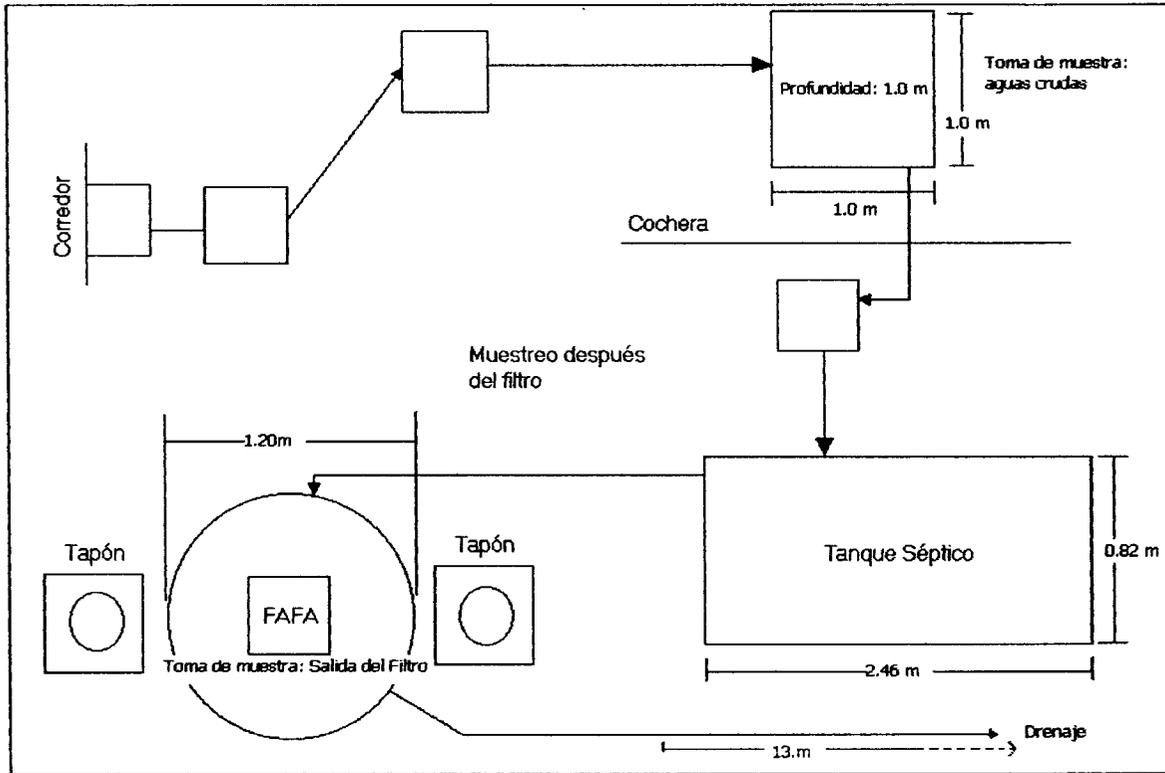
Esquema en planta del sistema: Tanque - FAFA - drenaje
